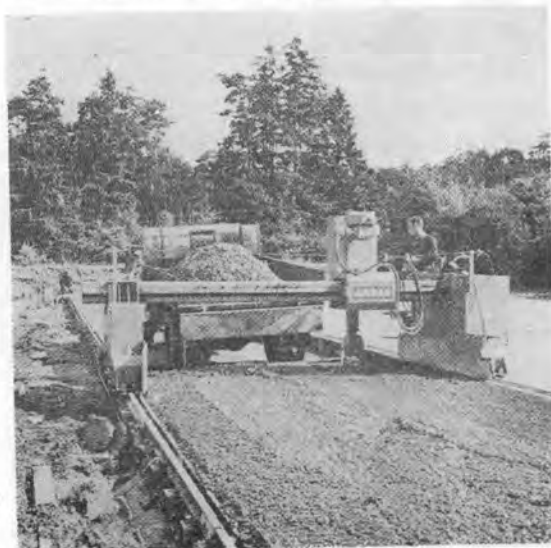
コンクリートおよびアスファルトの両舗装工事に用いられる大形フィニッシャ
